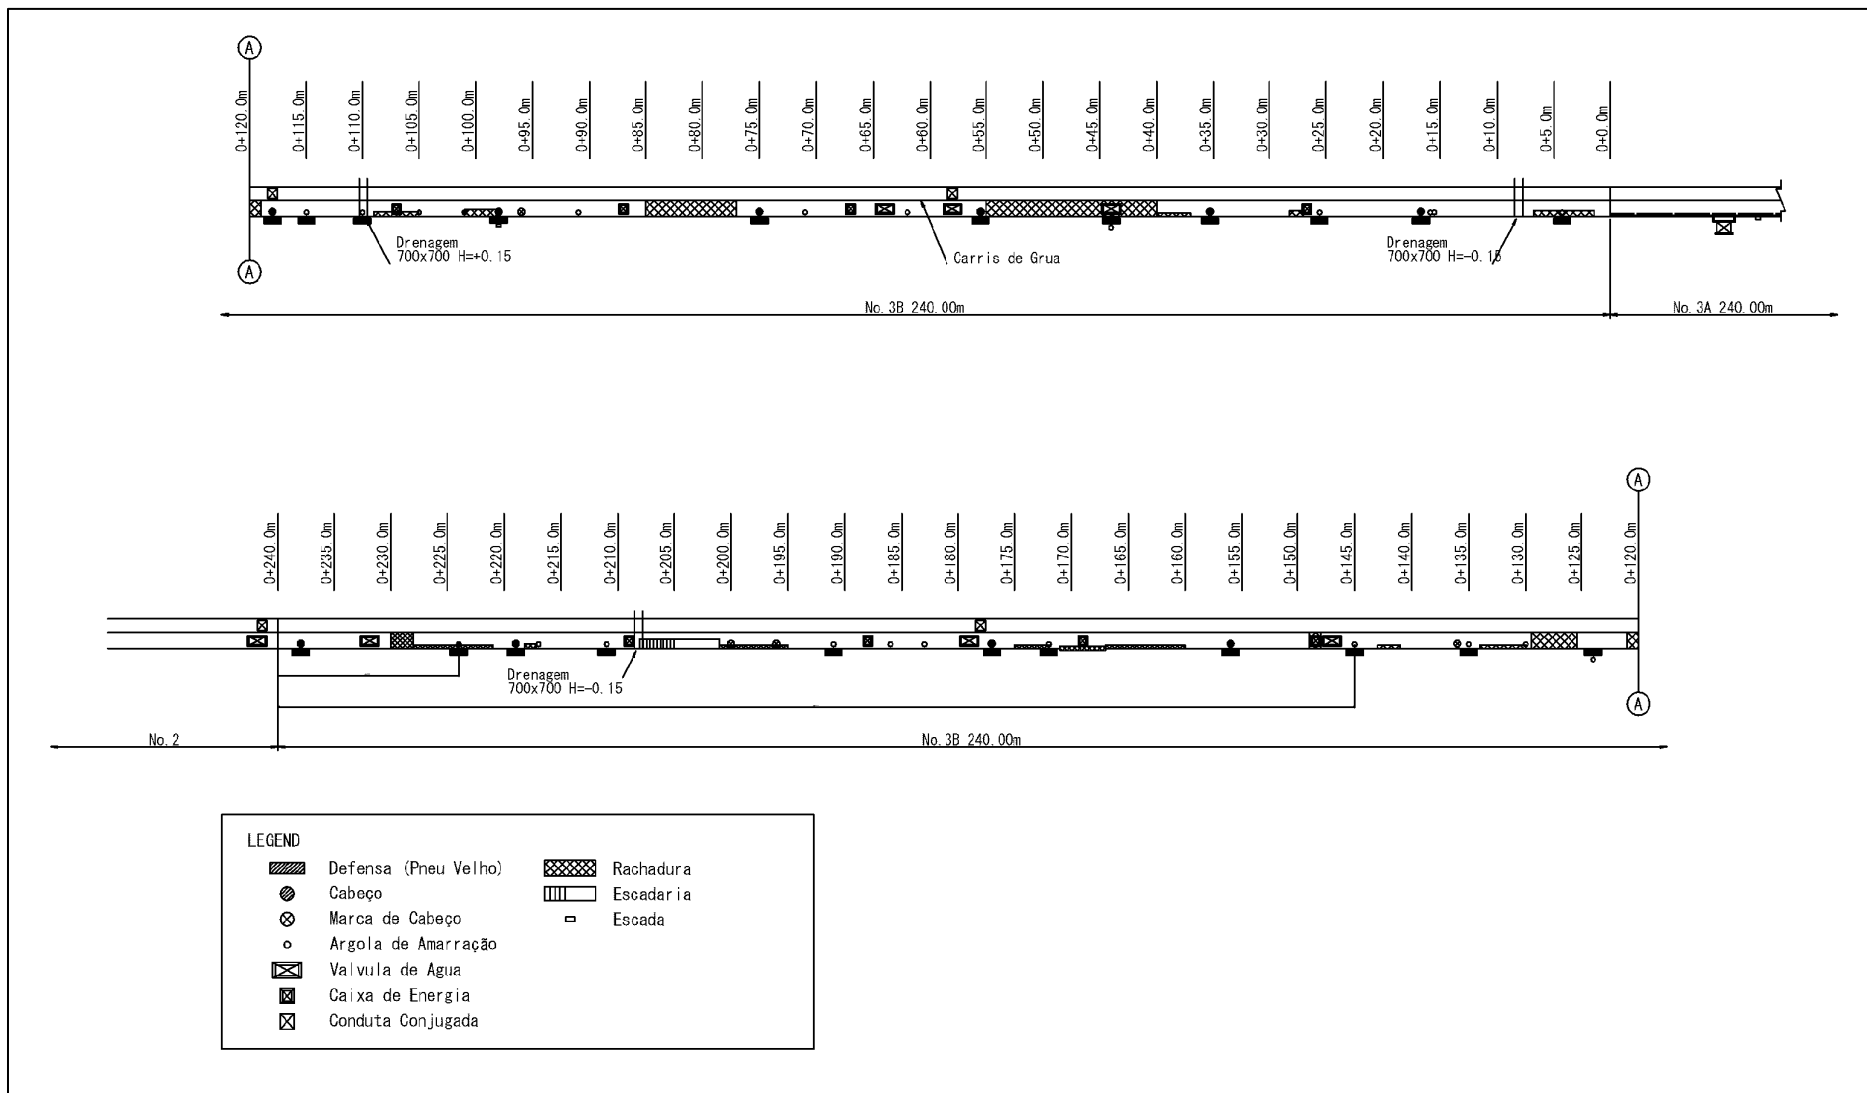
Planimétrica da Situação da Zona 3B do Porto do Namibe
